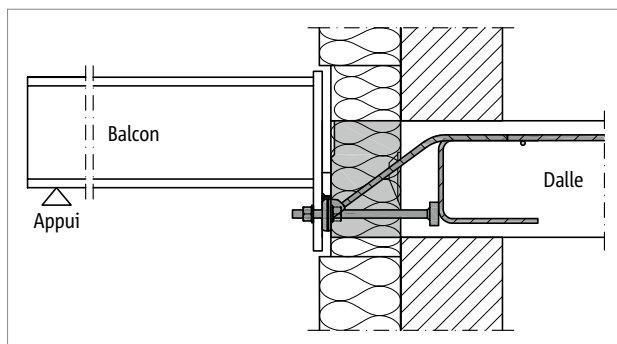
Schöck Isokorb® XT type SQ : passage sans obstacle grâce au décalage en hauteur
